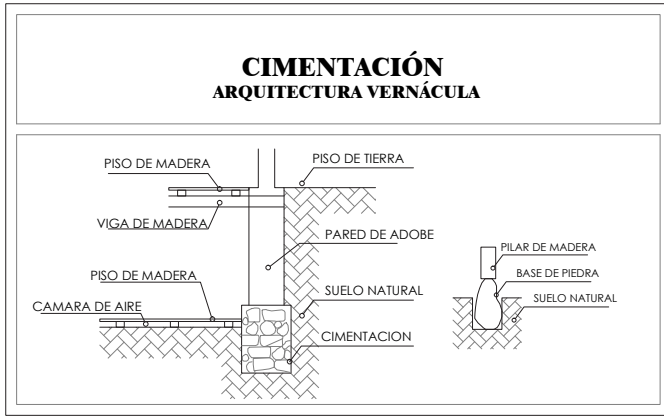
Armado y montaje de cimentación en la arquitectura vernácula.
